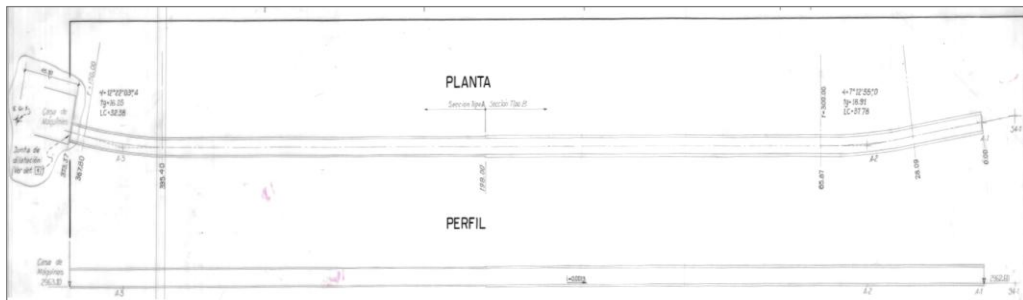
Vista en planta y perfil del túnel de acceso hacia la Casa de Máquinas de la Central Hidroeléctrica de Charcani V.
